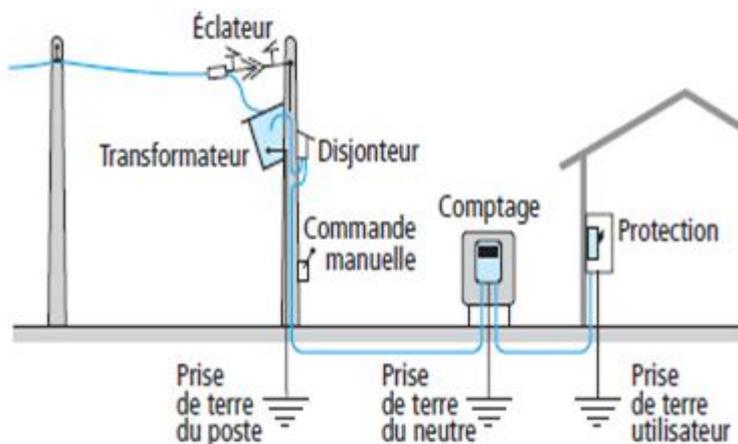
Structure d'installation d'un poste sur poteau.
